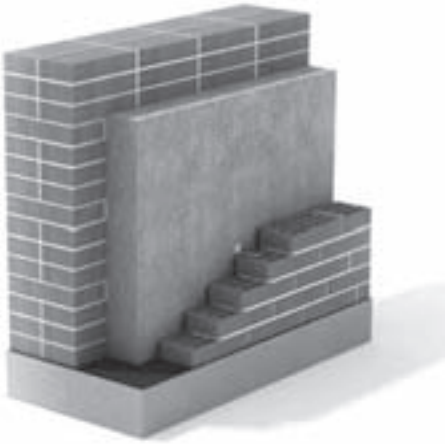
Утеплення фасаду в середині стіни.
